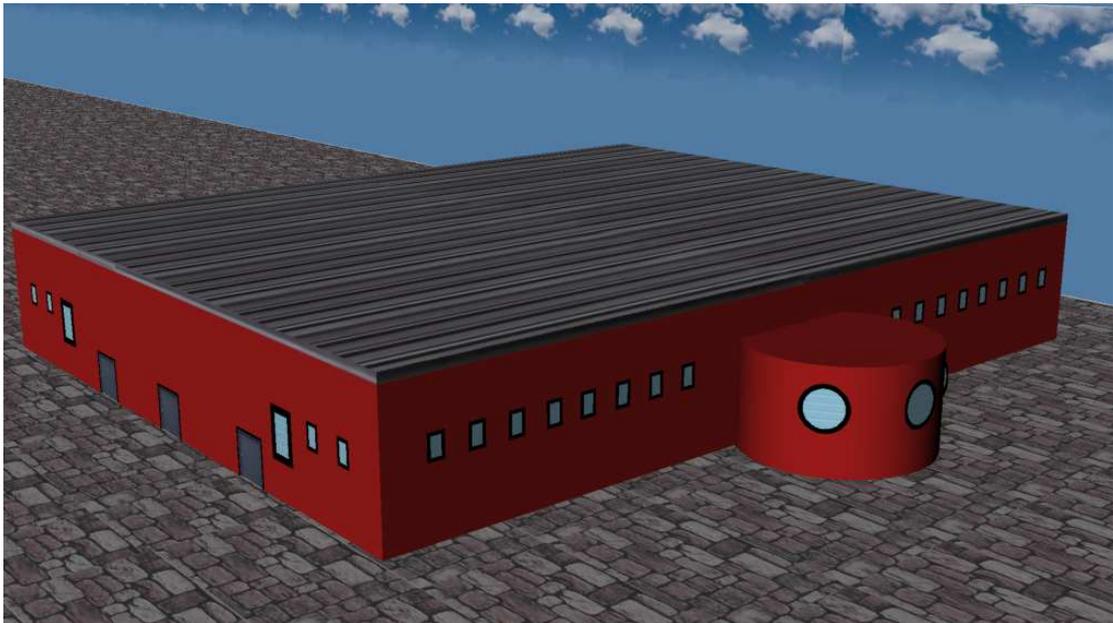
Se muestra la planta arquitectónica del cuarto boceto
